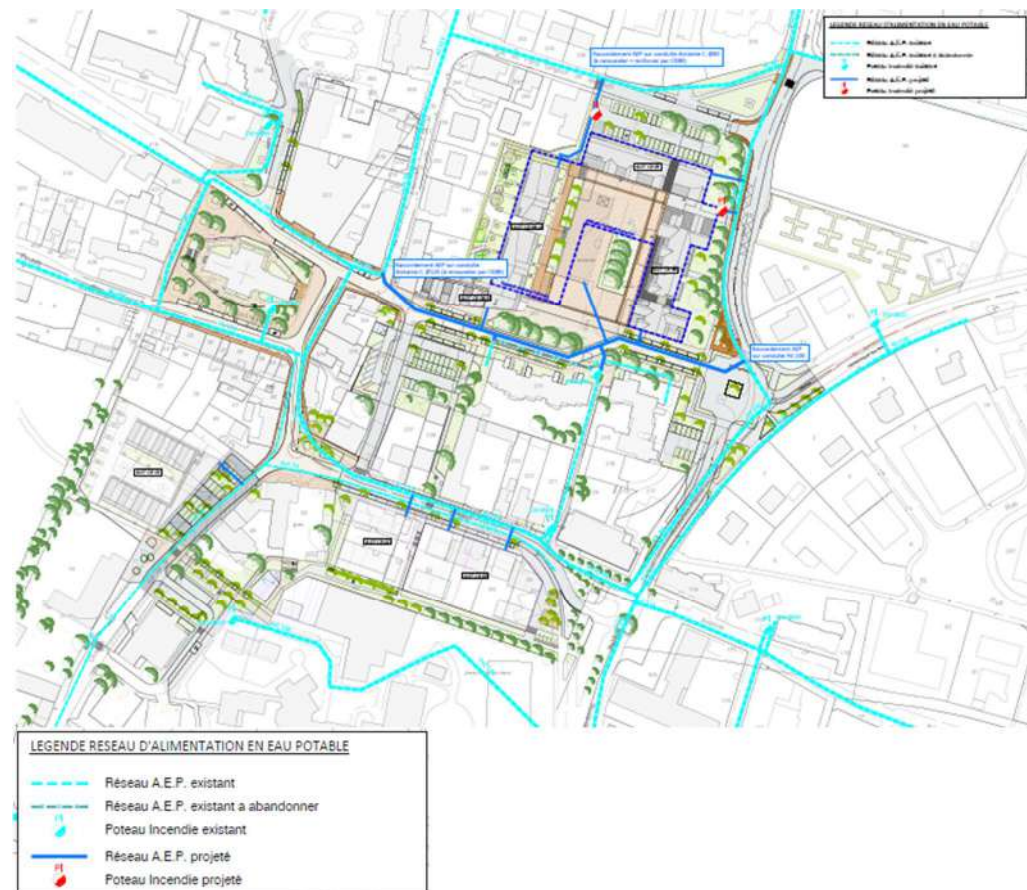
plan du réseau d'alimentation en eau potable, secteur Centre-bourg - Stade AVP
